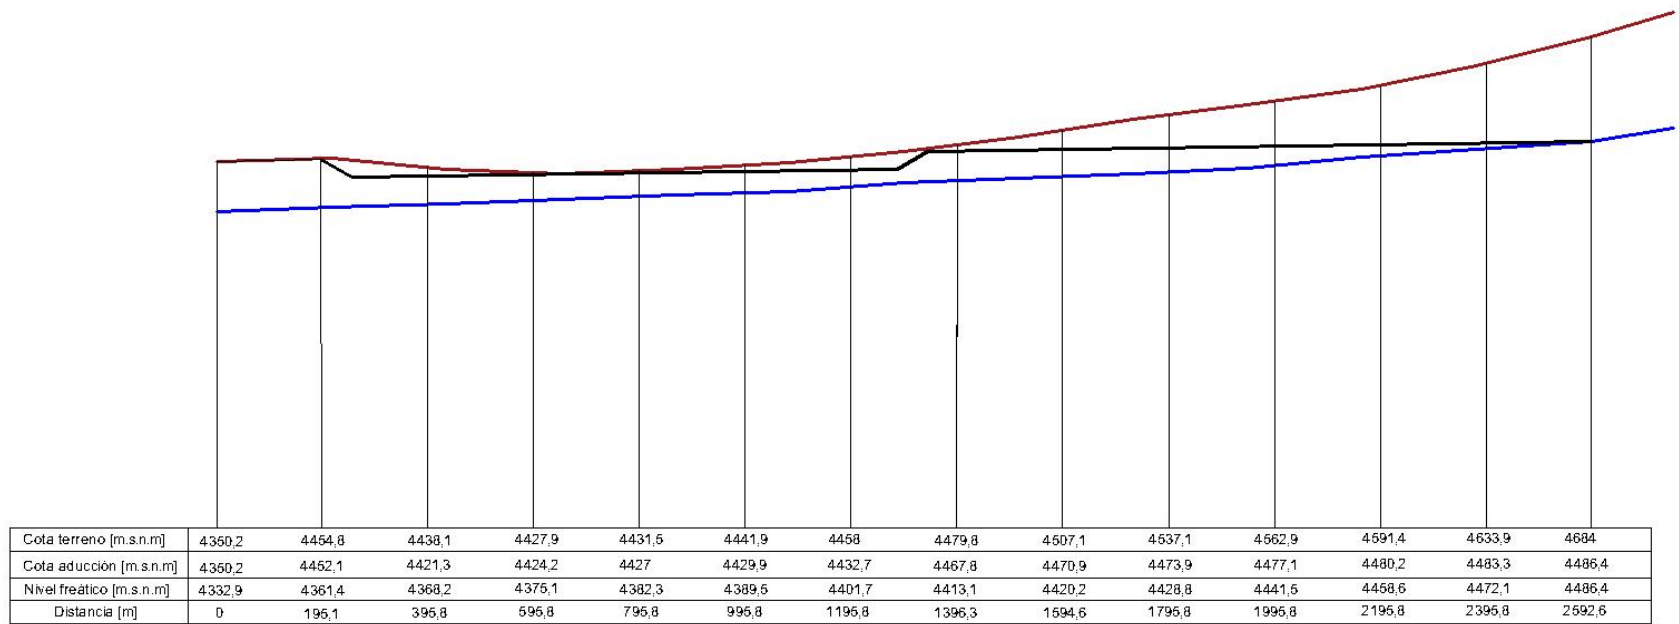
Perfil longitudinal de aducción en Quebrada 5.
